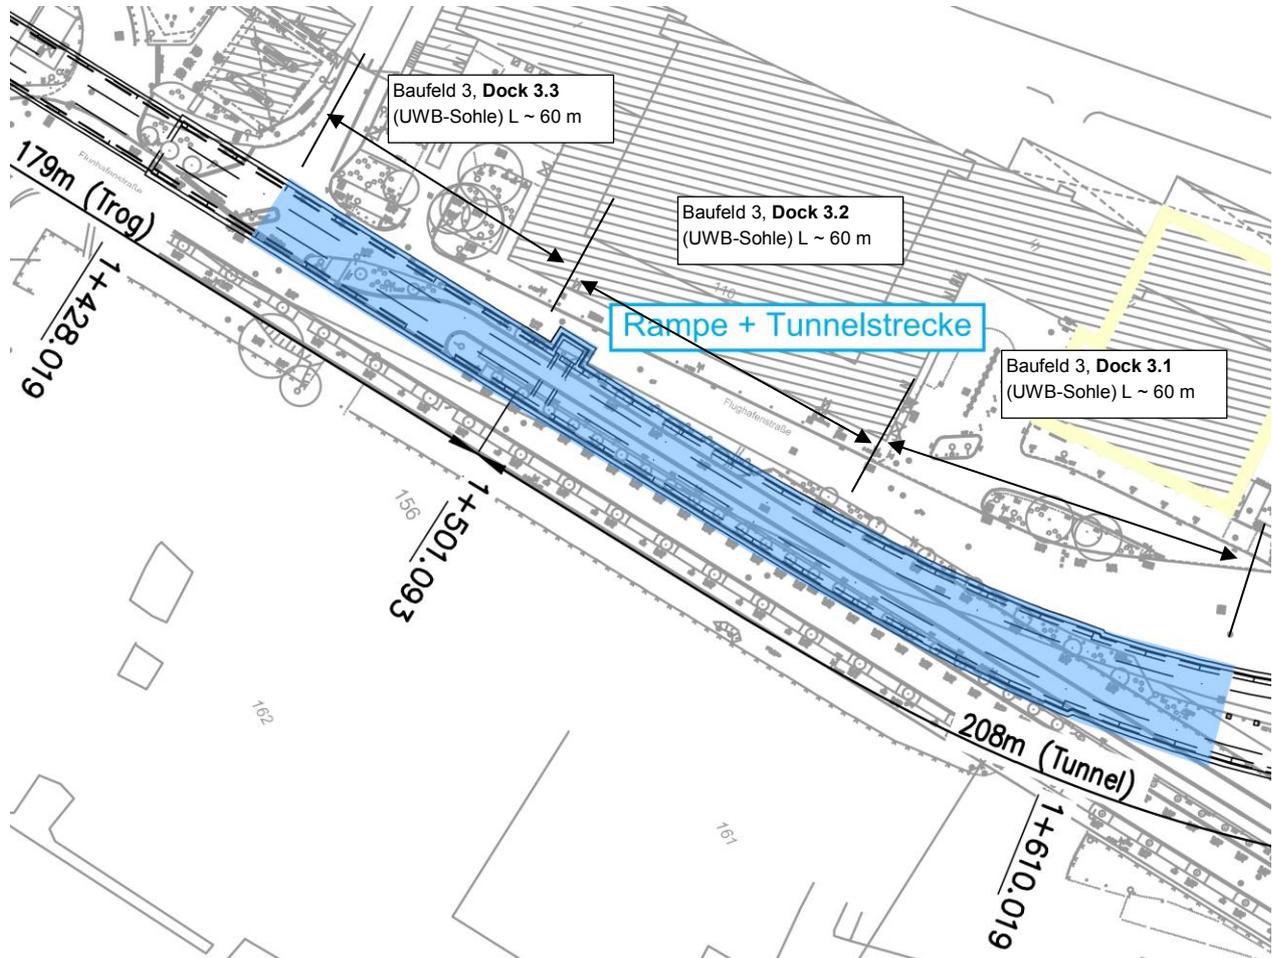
Übersicht der Baugrube „Rampe + Tunnelstrecke“
